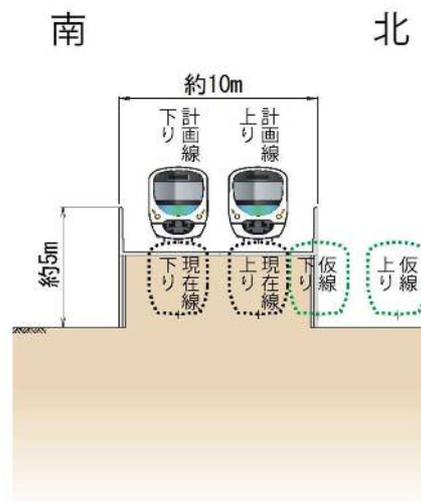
(2) 一般部 (A-A' 断面：擁壁) 標準断面図
